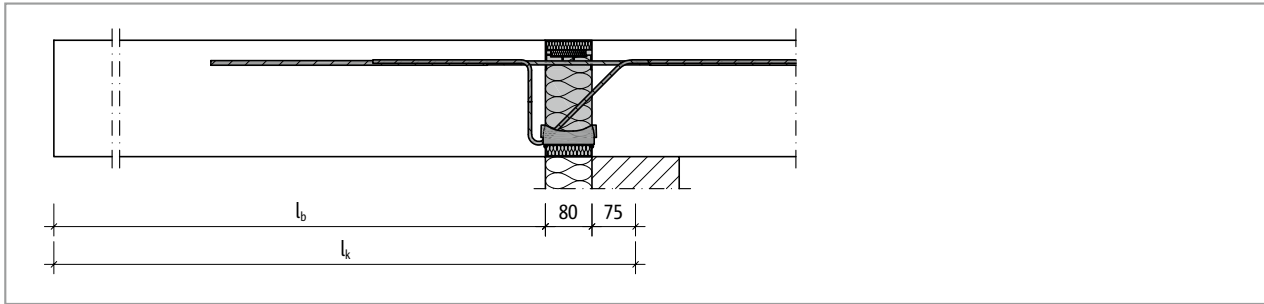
Schöck Isokorb® T tipo K: Longitud de voladizo del sistema (l_k) para el cálculo y la longitud geométrica del voladizo (l_b)
